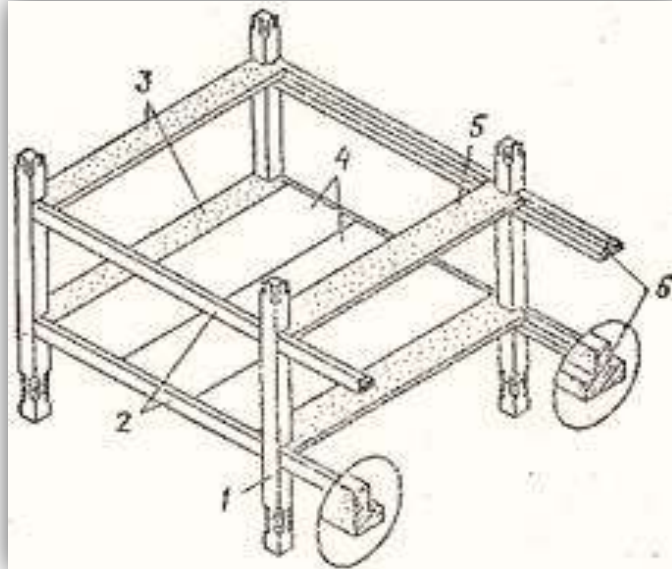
Конструктивные элементы сборного железобетонного каркаса гражданского здания
